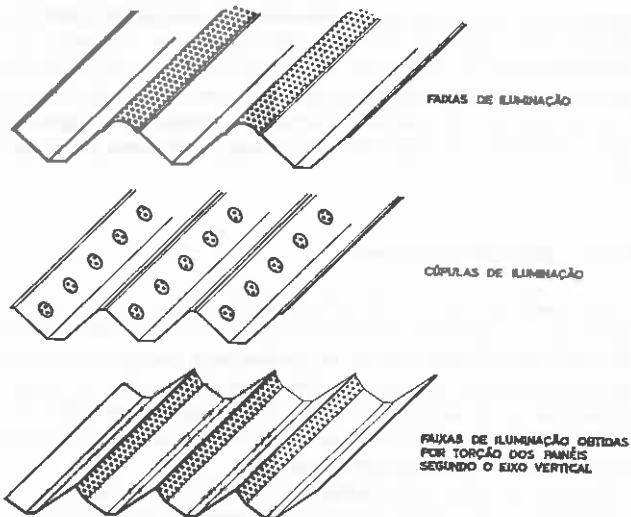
Claraboias ou faixas de iluminação em painéis plissados (2)
